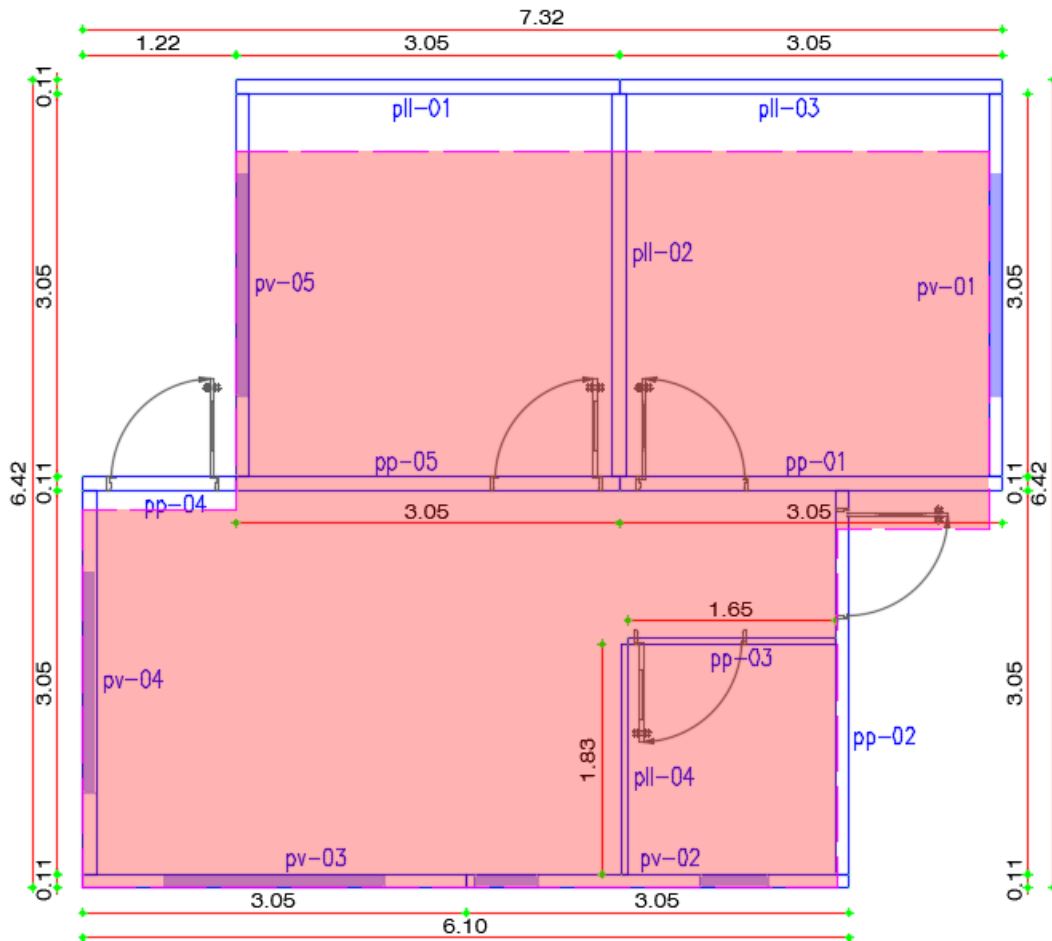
Planta Arquitectónica Modulada e Identificación de Paneles
